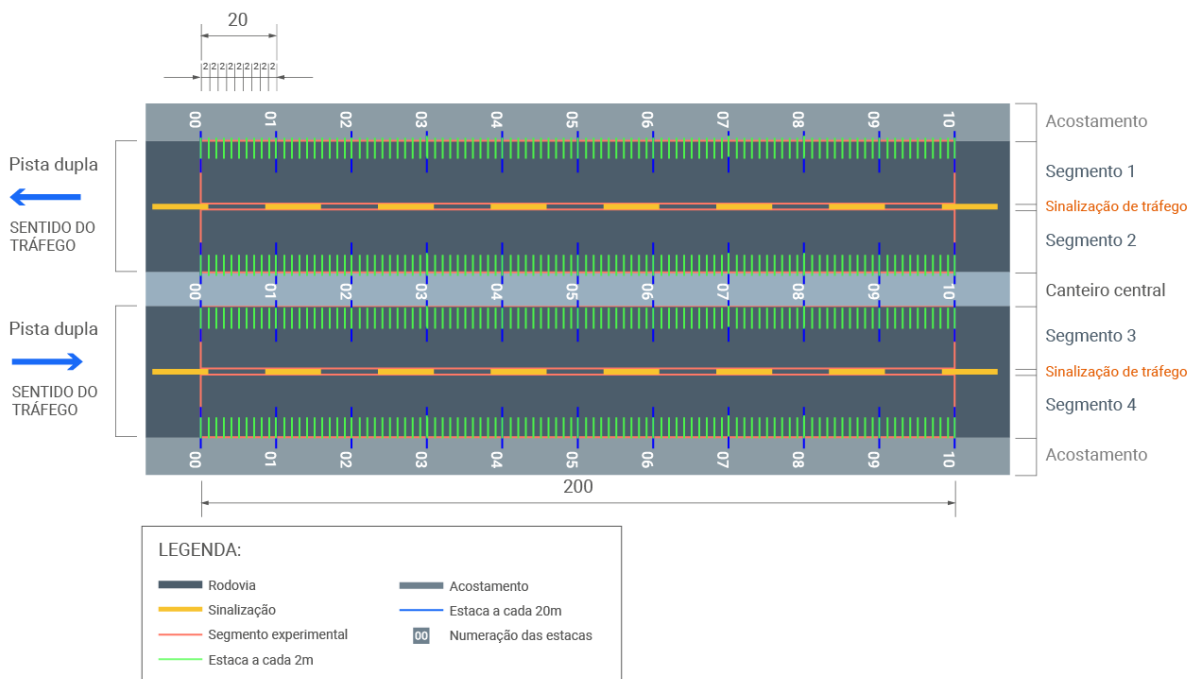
Pista dupla – Marcações secundárias espaçadas a cada 2 m
